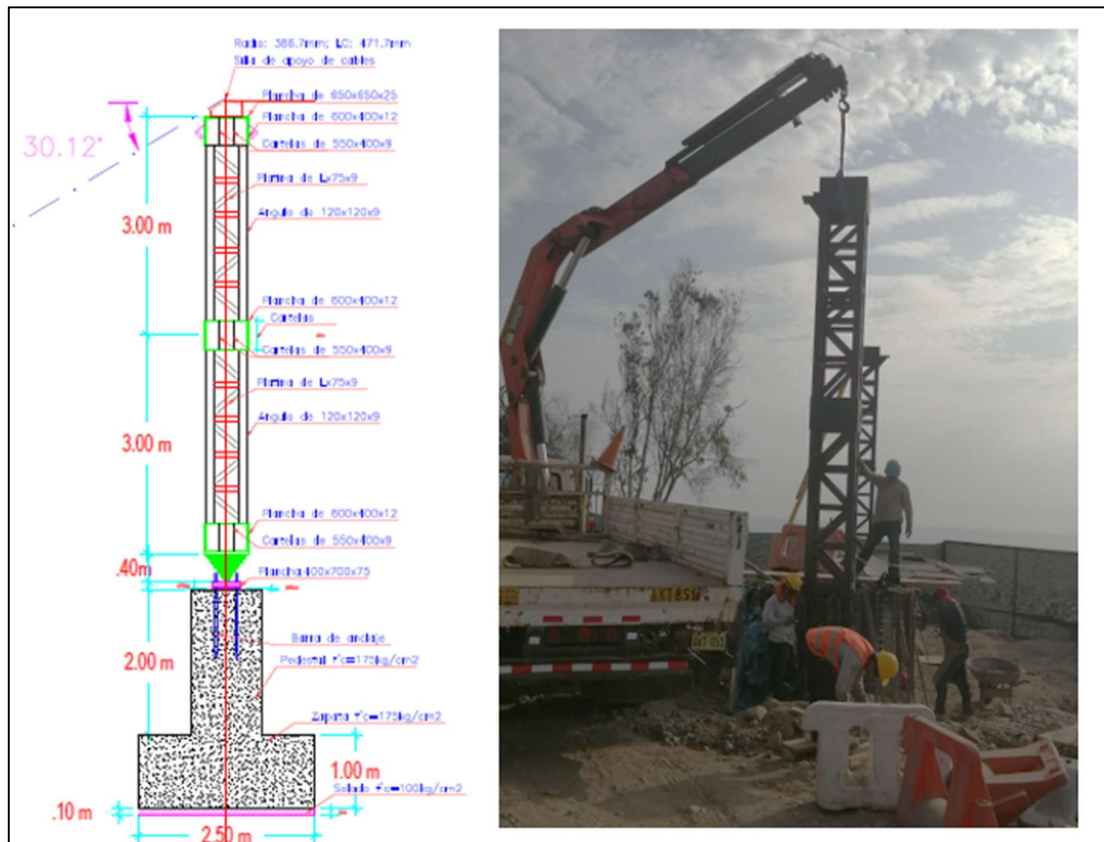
Detalle de la Torre metalica\_ Lanzamiento de E. M.
